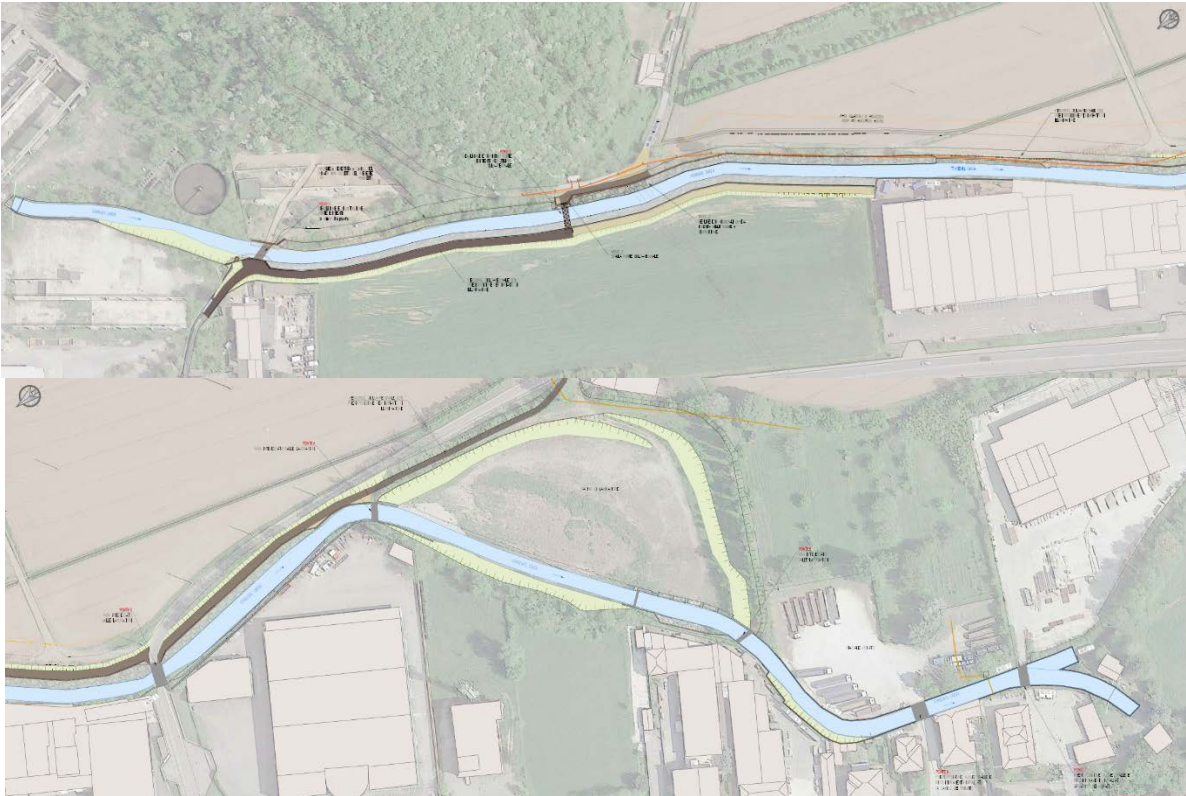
Legenda Tavola 4. Stato di progetto, planimetria generale.
